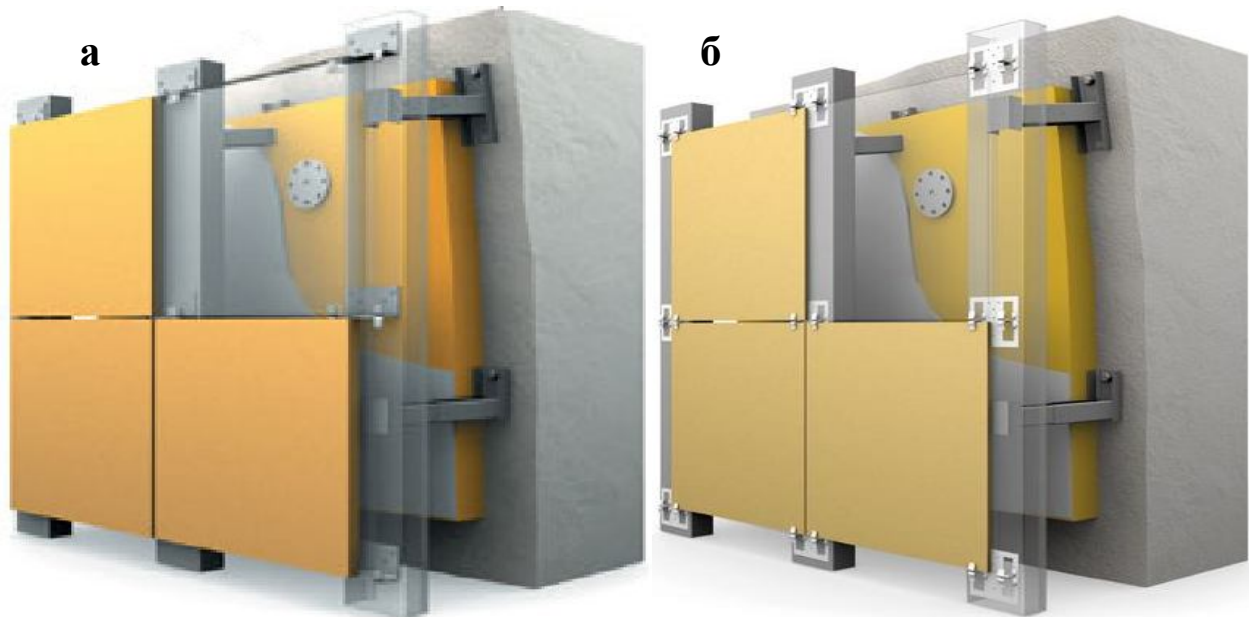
Вентилюваний фасад із керамогранітних плит:
